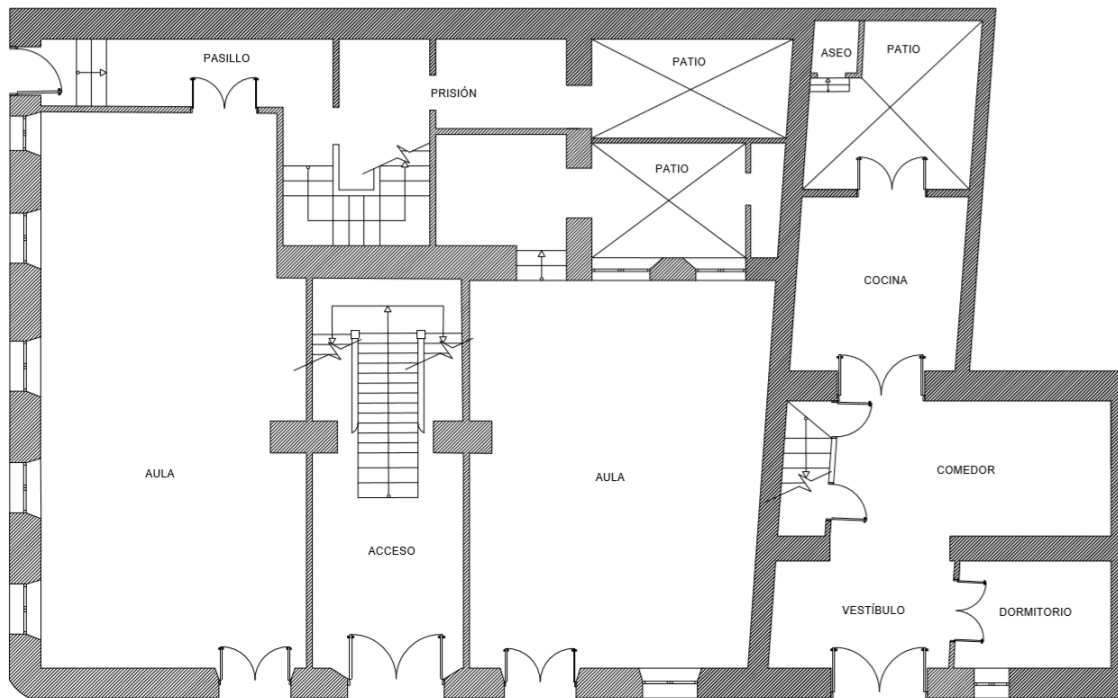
Plano planta baja, anterior a 1984. Fuente: elaboración propia, creación 20/06/2019
